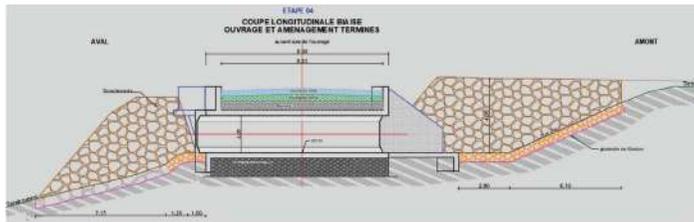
Vue en coupe longitudinale de l'ouvrage projet
